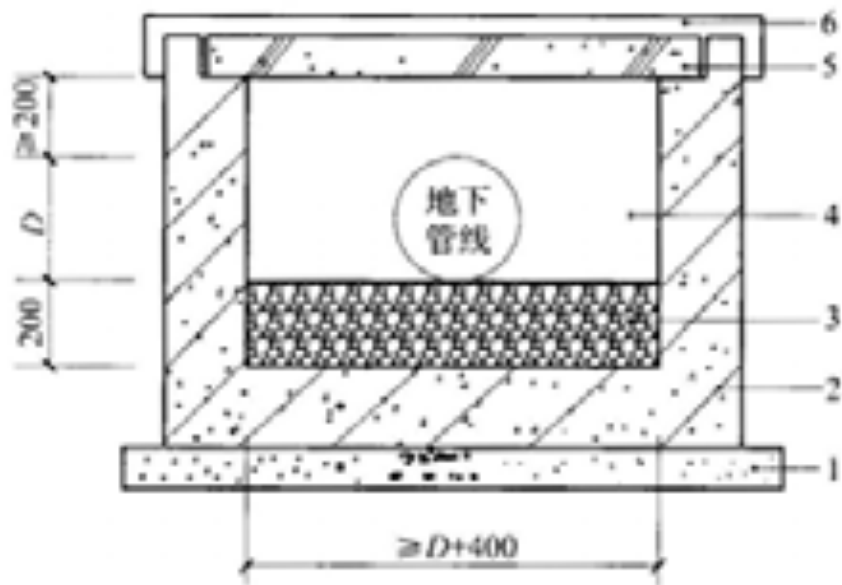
地下管道抗渗钢筋混凝土管沟防渗层示意图
